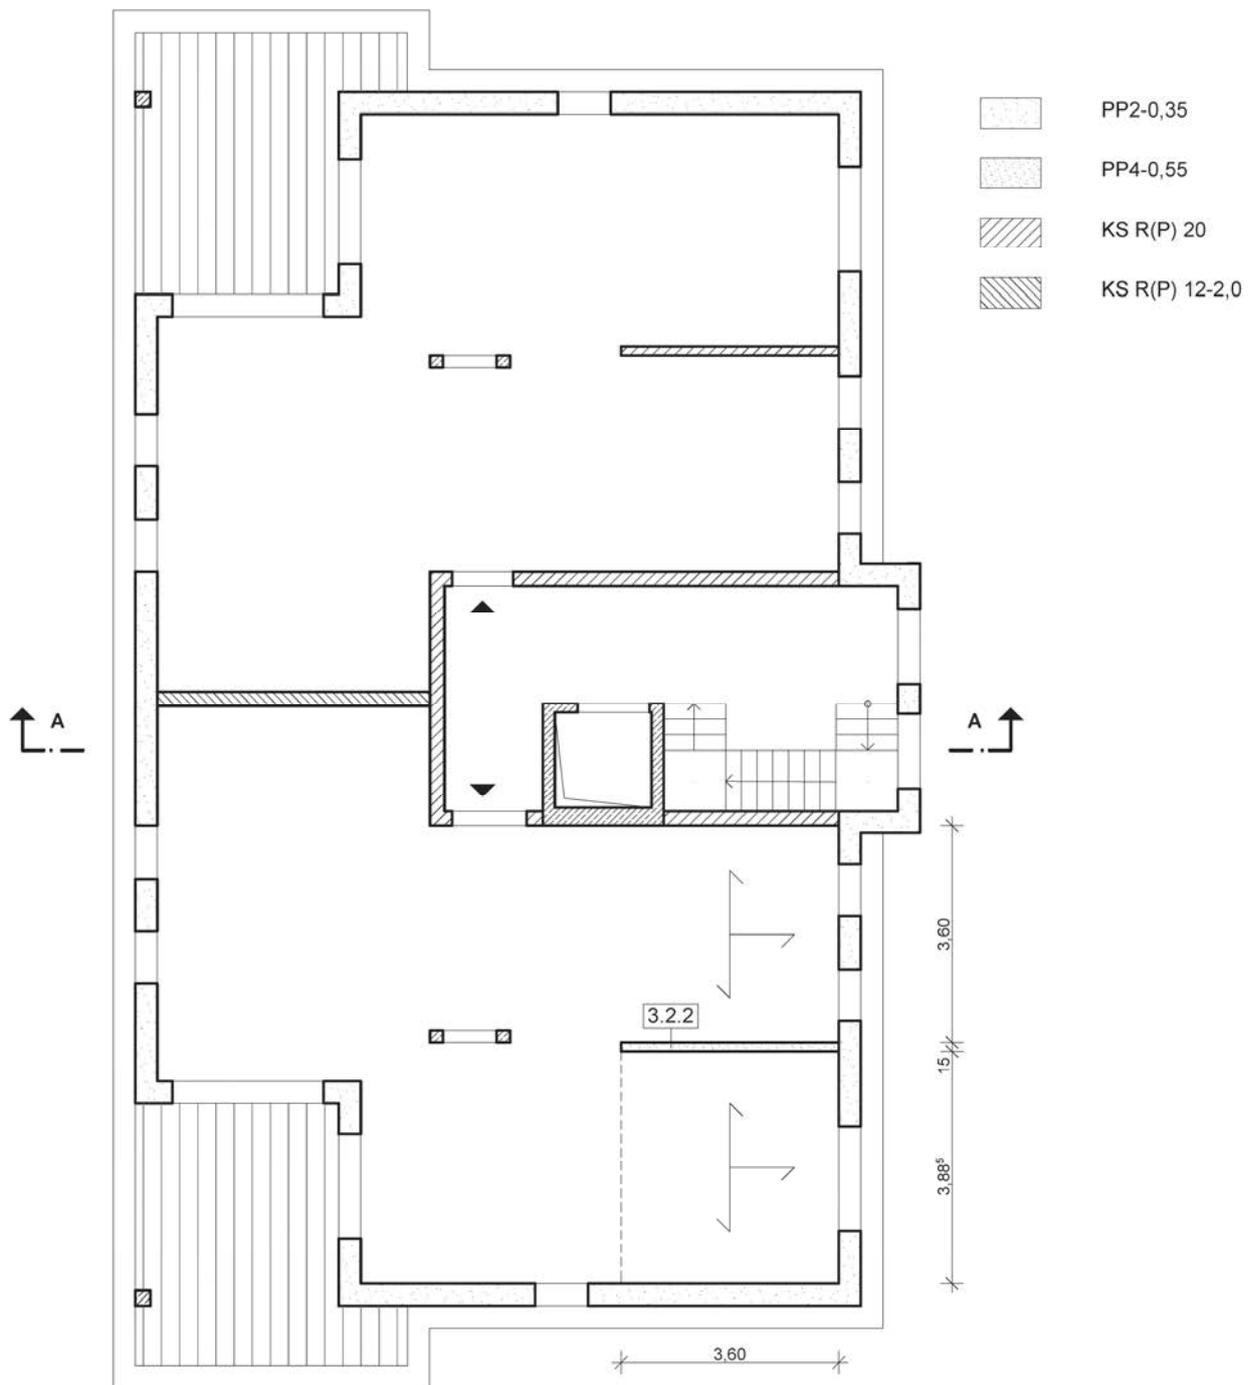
Mehrfamilienhaus in Dresden, Grundriss Staffelgeschoss
